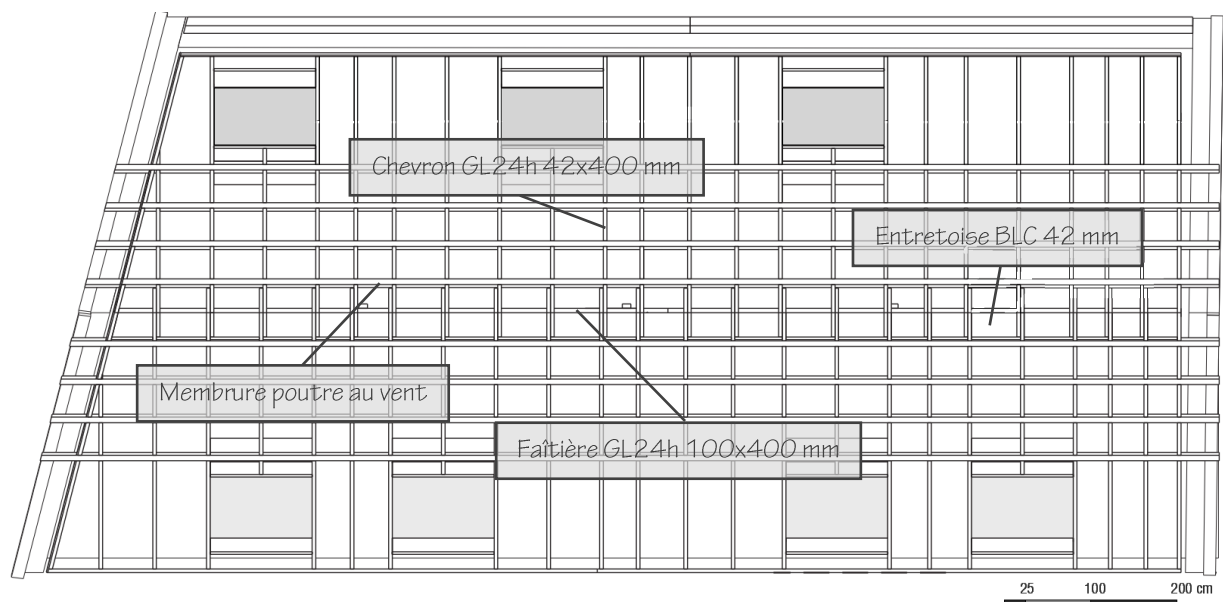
Plan détail de la structure de la toiture (Source : Bureau Modelmo, 2010)
